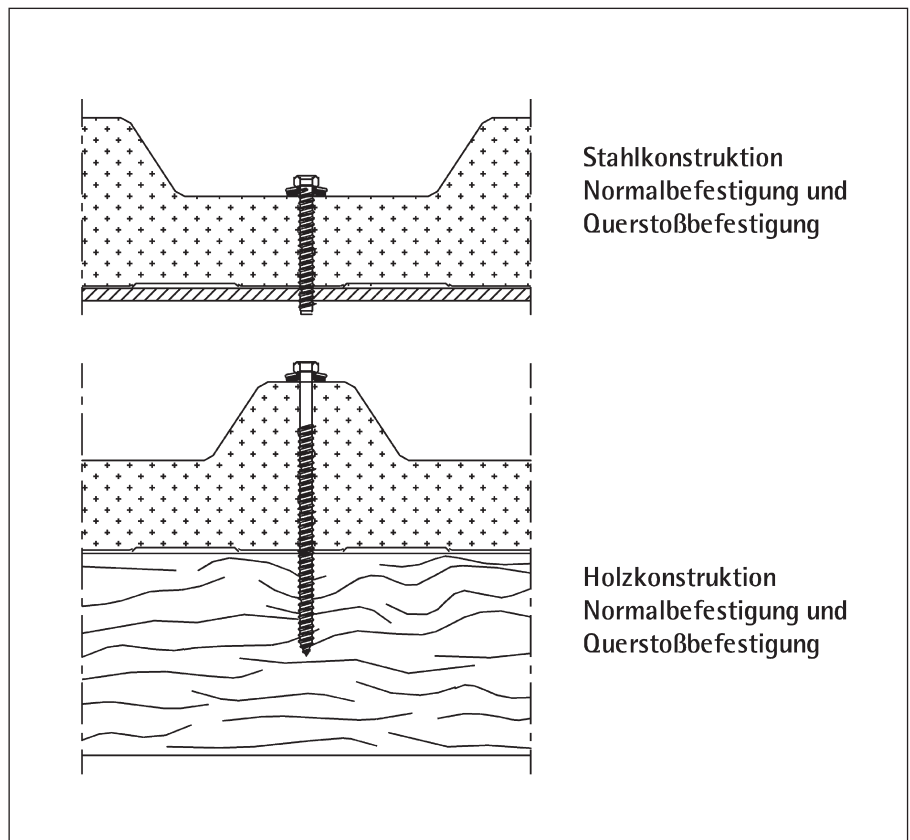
Befestigung von Dach-Sandwichelementen mit Stahldeckschalen
